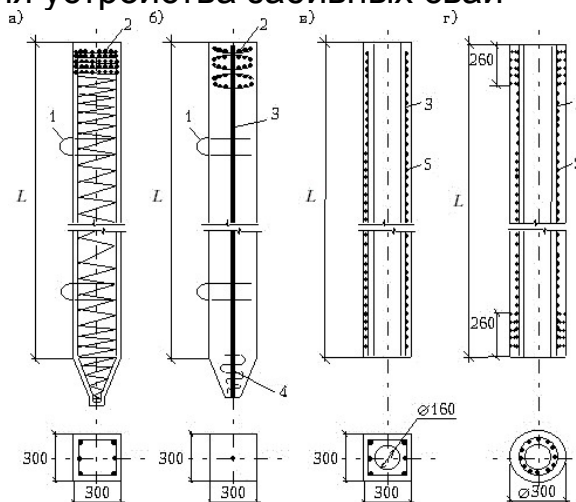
Конструкция забивных железобетонных свай. а) – призматическая свая с поперечным армированием ствола; б) – призматическая свая без поперечного армирования ствола; в) – призматическая свая с круглой полостью; г) – полая круглая свая; 1 – строповочная петля; 2 – арматурные сетки головы сваи; 3 – продольная арматура; 4 – спираль остря; 5 – поперечная спиральная арматура.
